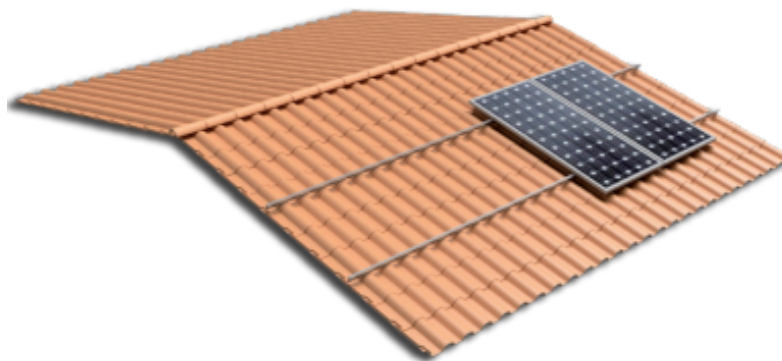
Disposición longitudinal sistema coplanario continuo atornillado para cubierta de teja. Fuente: Atersa
